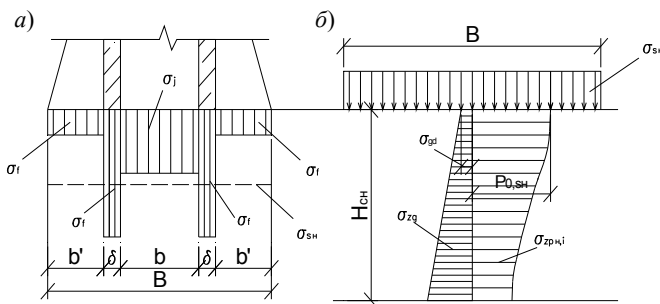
Схема к определению осадки нижнего слоя s_n
